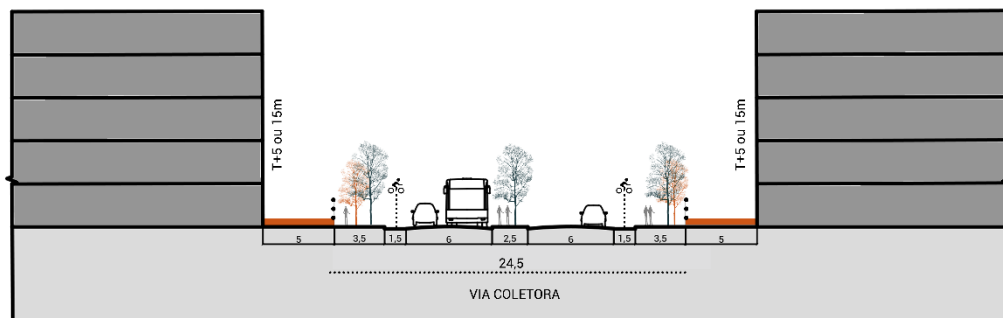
Corte esquematizado via coletora. Elaboração: Polo Planejamento, 2020.
